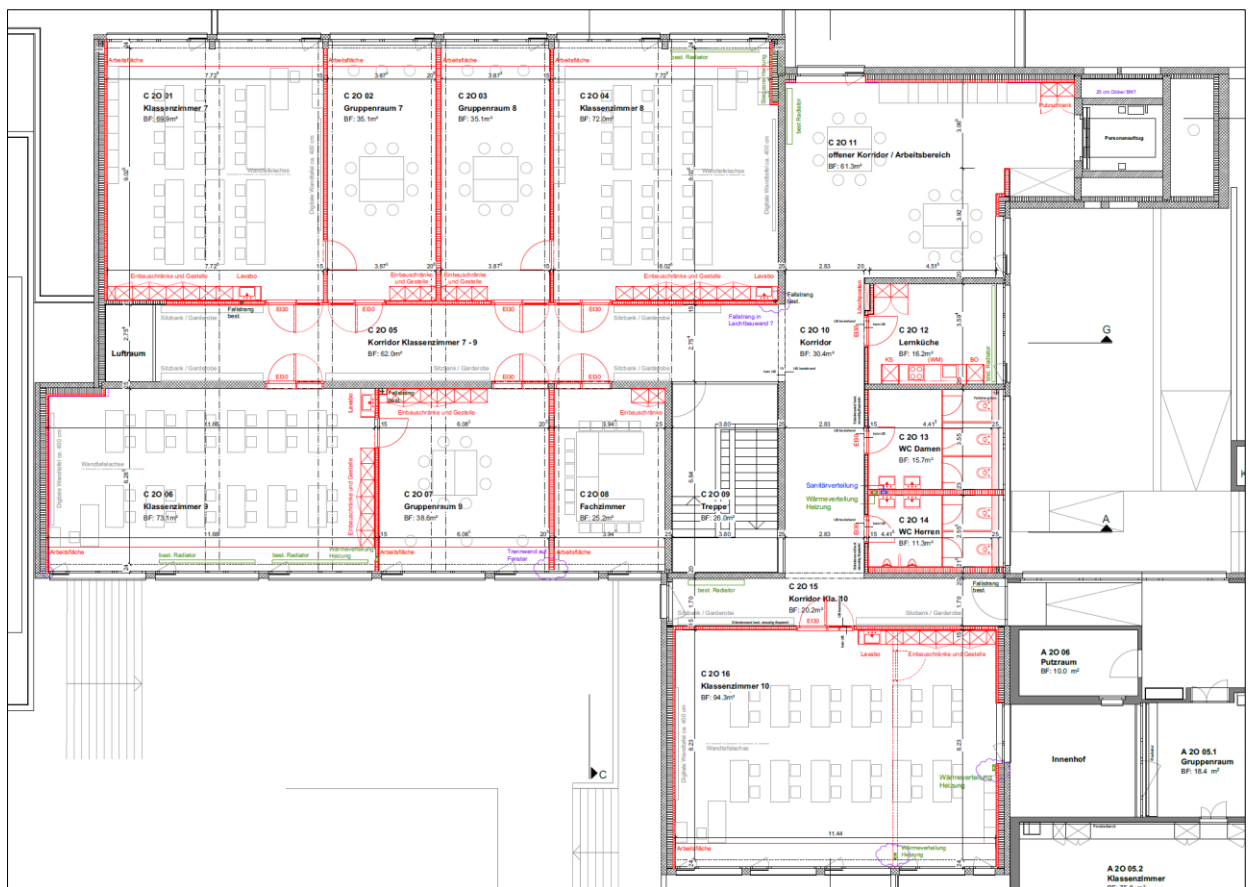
Plan Grundriss 2. Obergeschoss (Bauprojekt A6 Architekten AG vom 14.07.2025)
